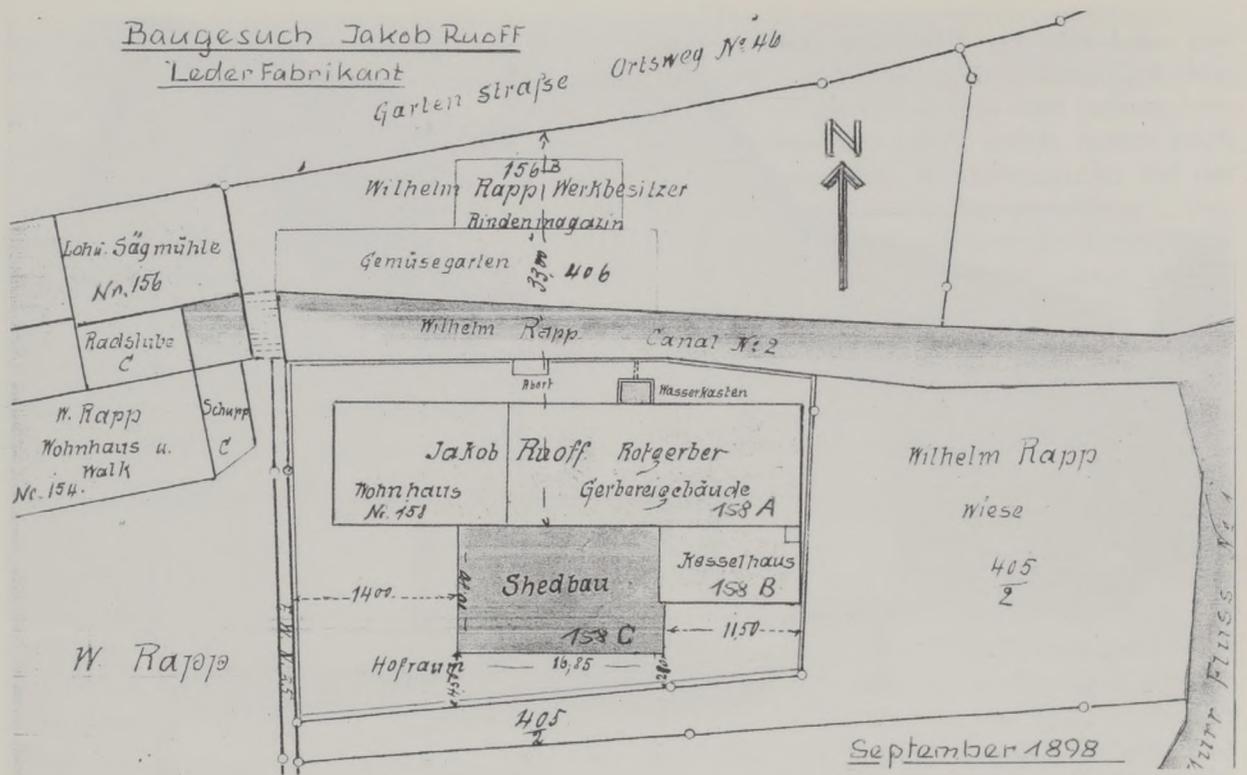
Lageplan der Lederfabrik Jakob Ruoff vom September 1898 mit dem geplanten Shedbau.
